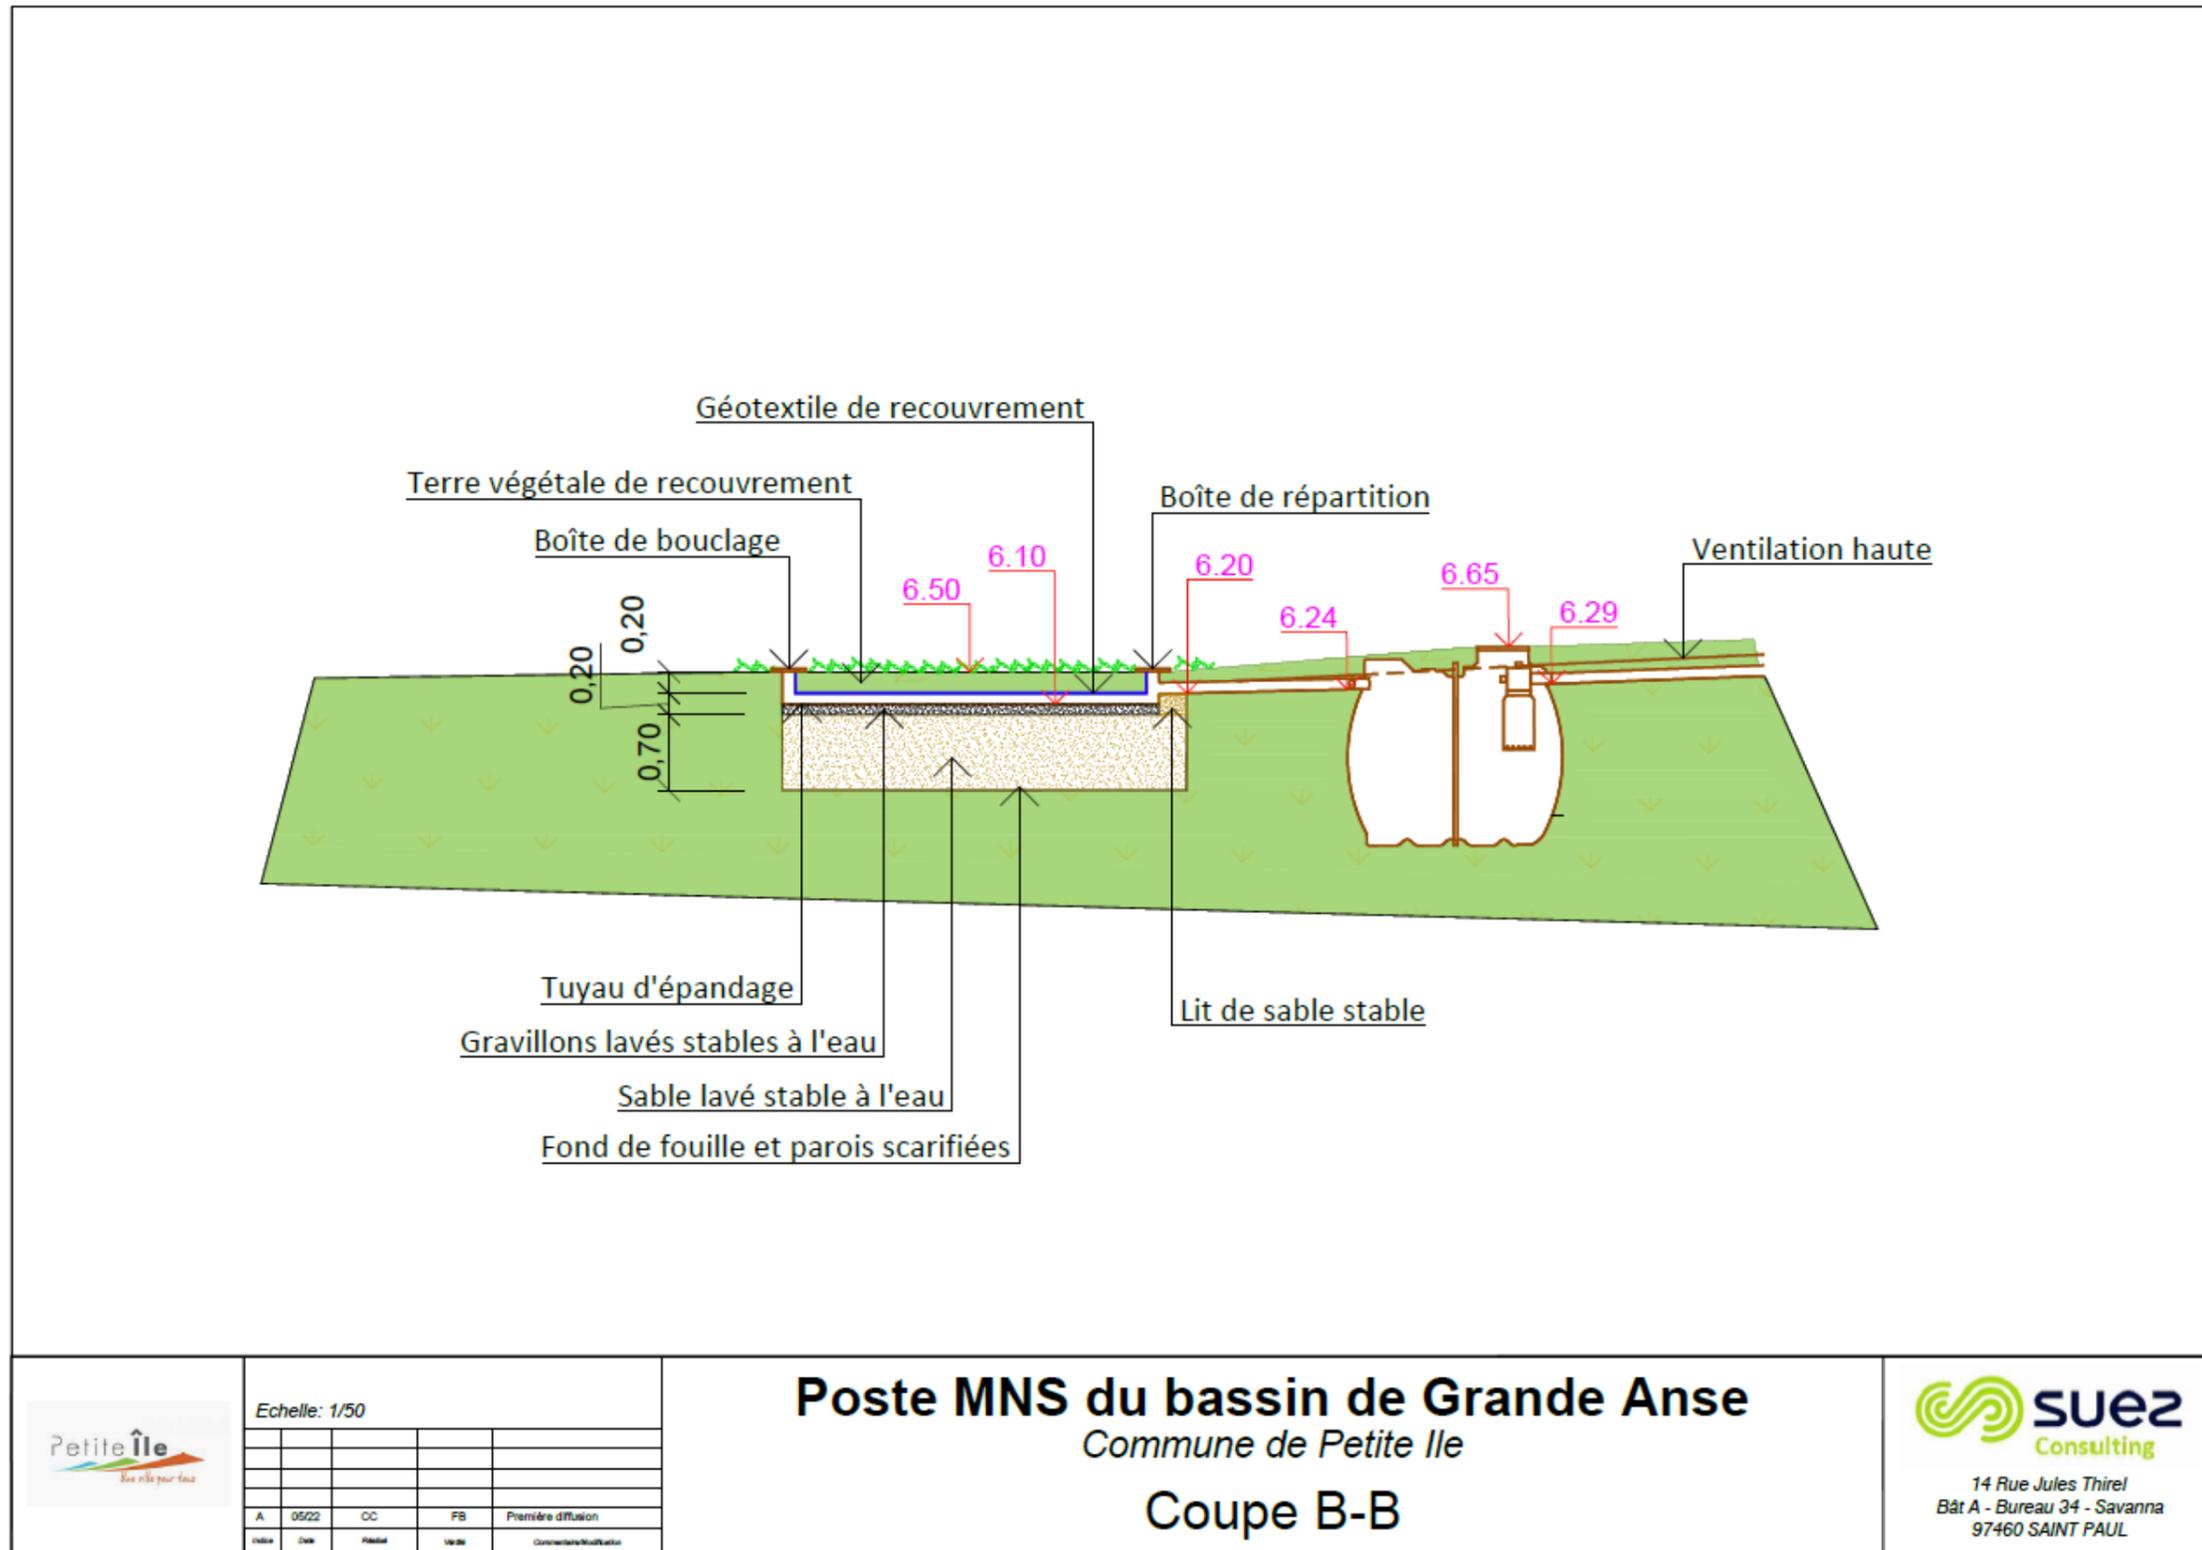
Plan de coupe B-B du système d'assainissement autonome envisagé
